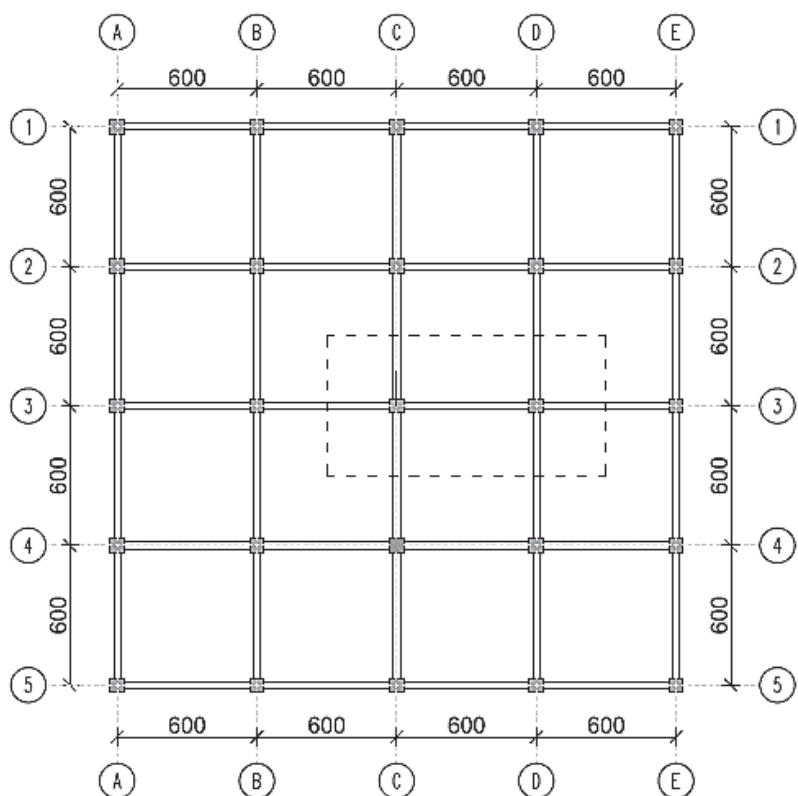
Planta piso tipo de las distintas configuraciones estructurales
